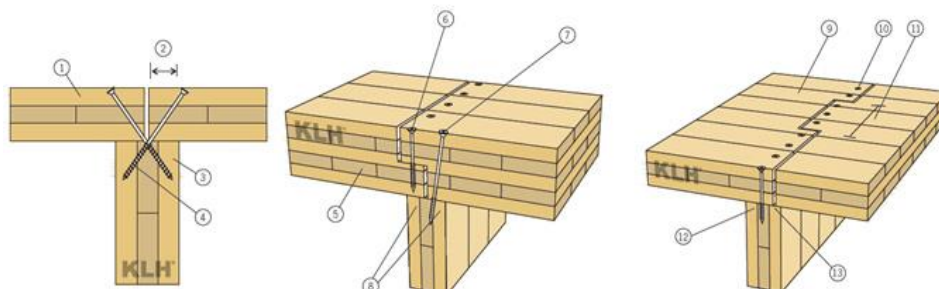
Parede contínua com ligação a pavimento de madeira (KLH Massivholz GmbH, 2013b).
